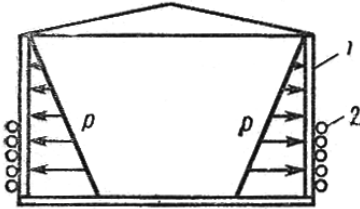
Усиление вертикальных цилиндрических резервуаров обмоткой высокопрочной проволокой: 1 — оболочка резервуара, 2 — обмотка
